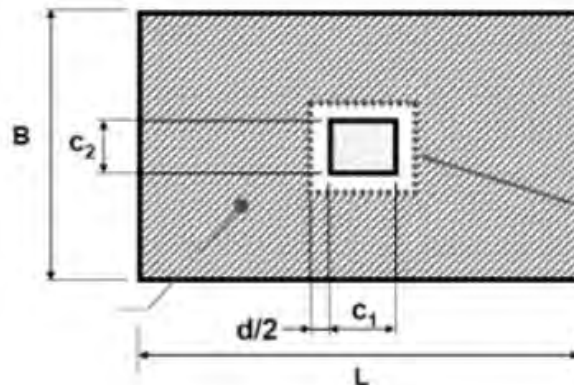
Sección de análisis para punzonamiento en zapatas aisladas
